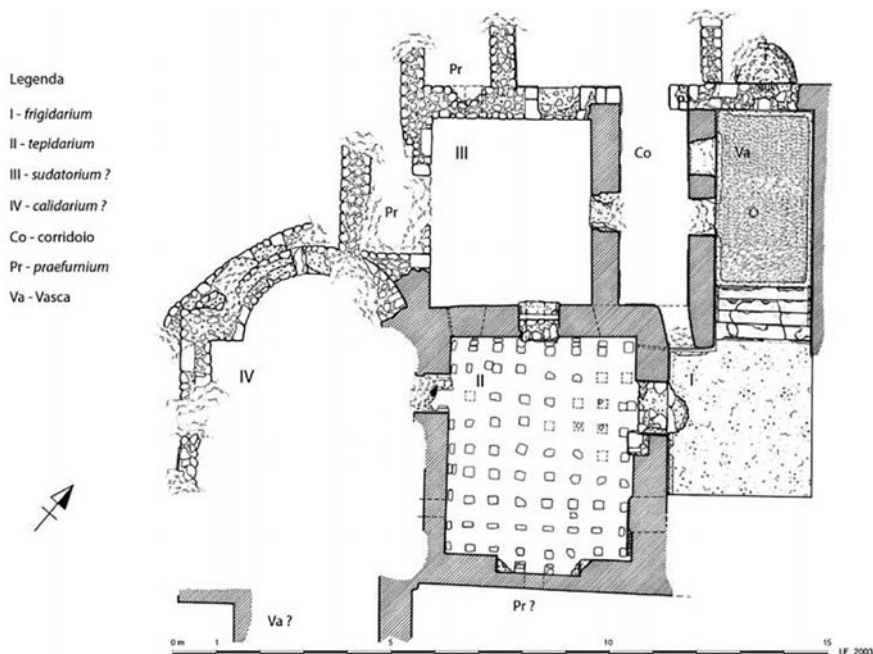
Planimetria del complesso termale (da FERRARI 2017).
